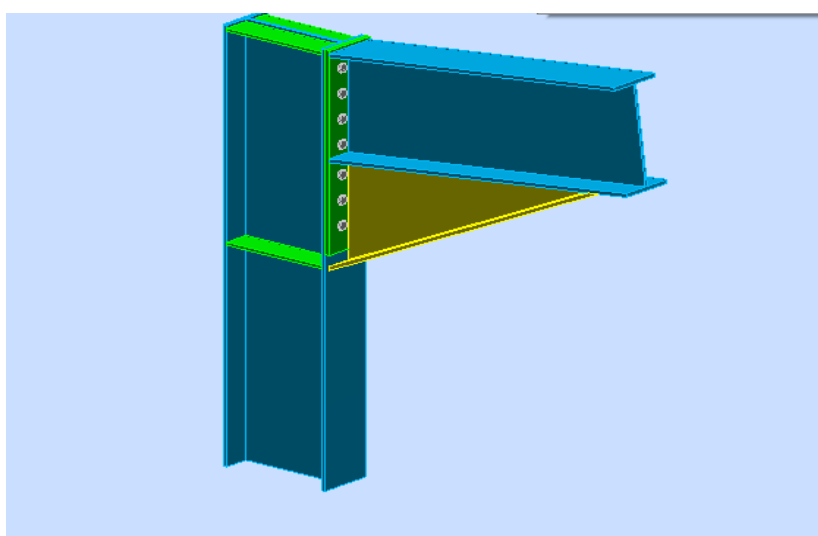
assemblage poteau-traverse (IPE360-IPE360)
